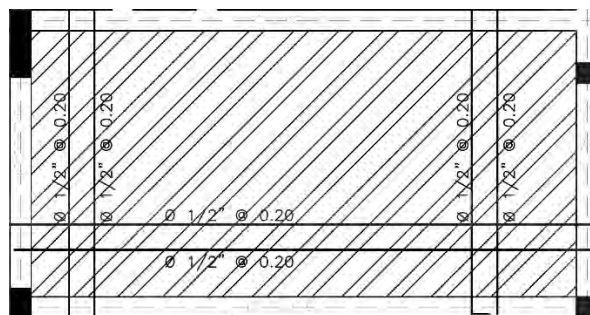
Vista en planta de distribución de acero en losa maciza entre ejes B-C / 6-8
